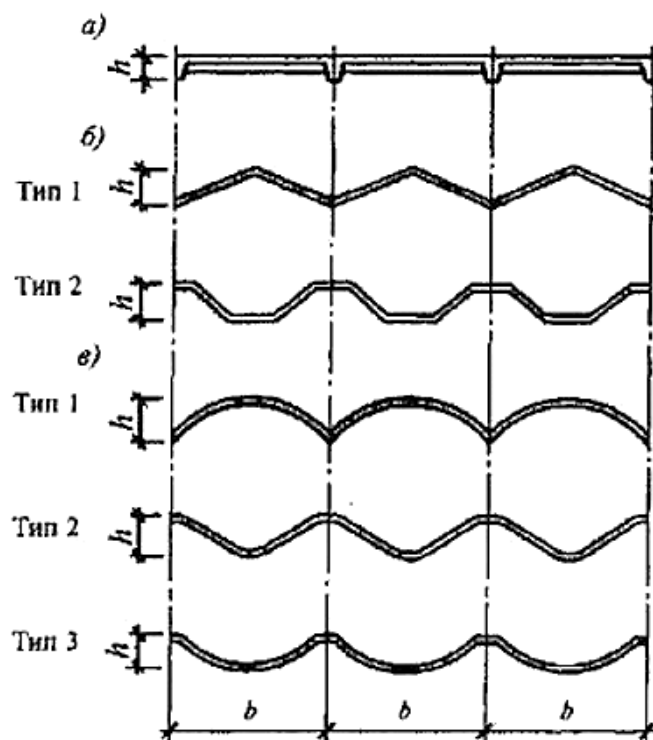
Поперечные сечения сводчатых покрытий
